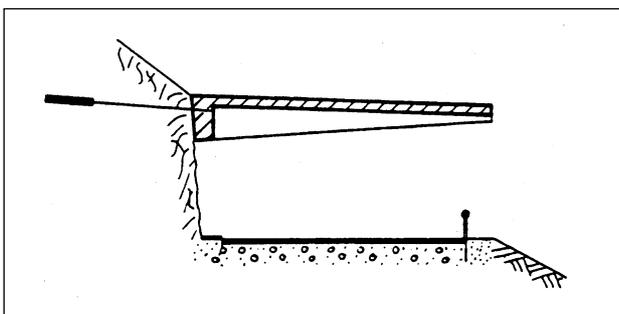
Galleria di protezione con sporgenza libera ed ancoraggio arretrato:
